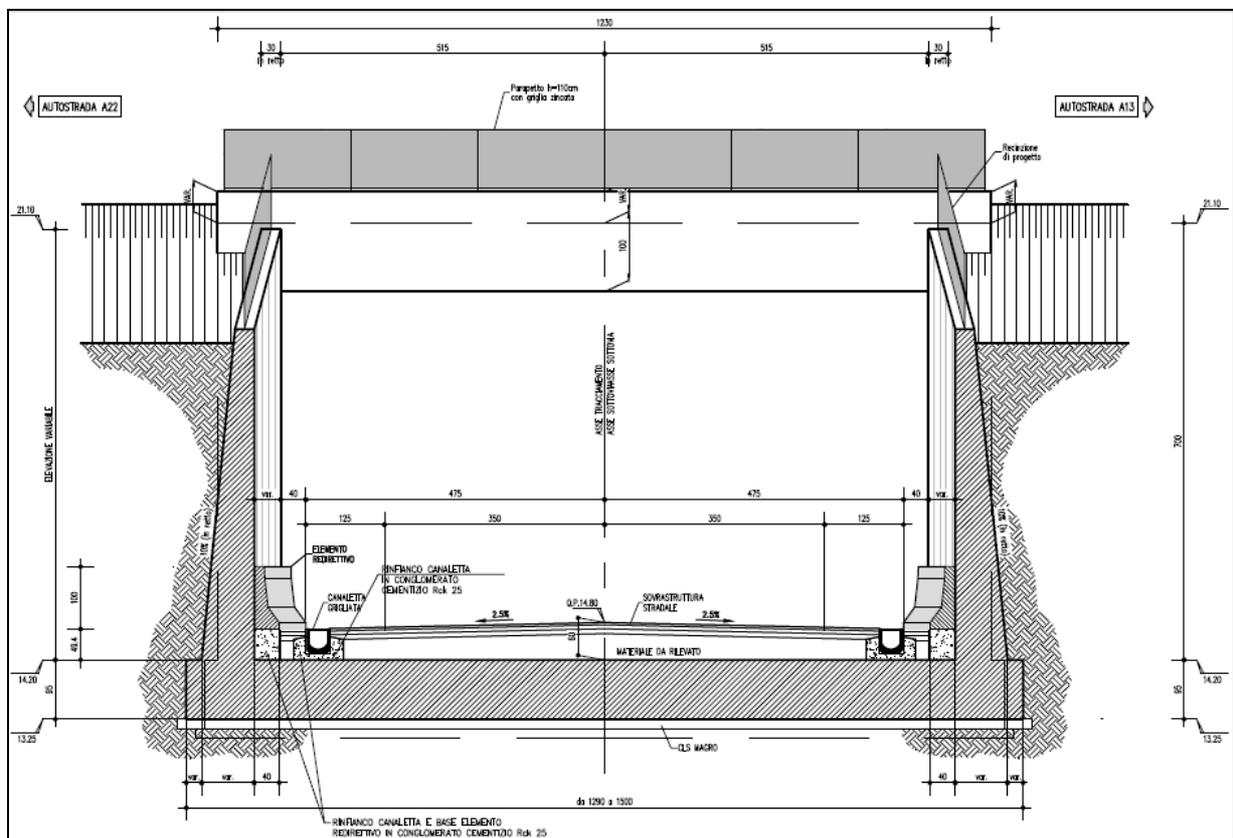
SEZIONE TRASVERSALE SUL MURO DI IMBOCCO AD "U"
